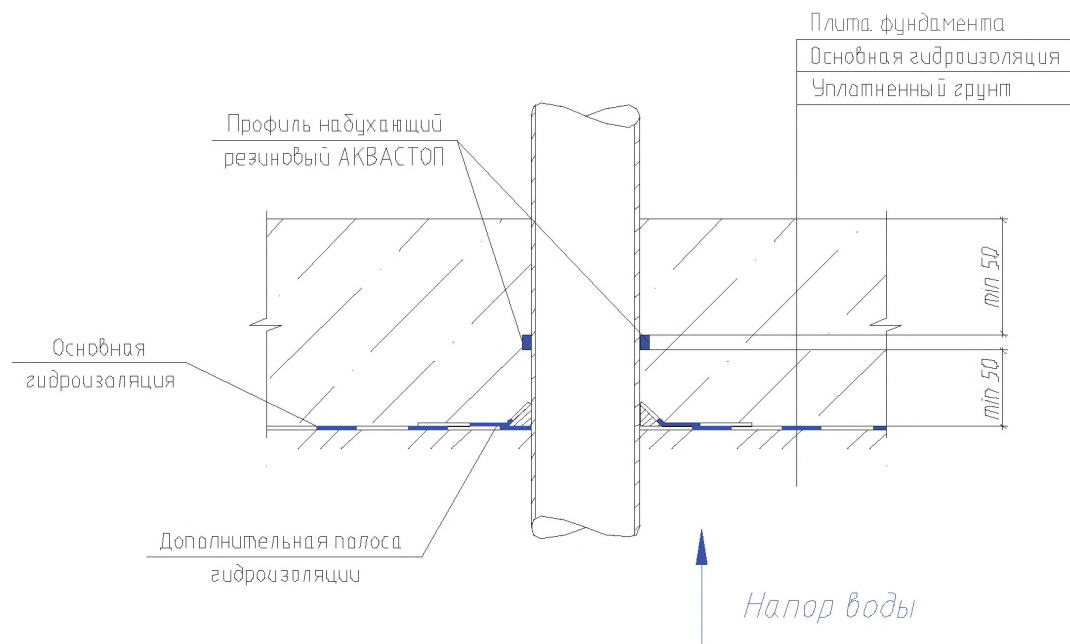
Пересечение трубы с фундаментной плитой
